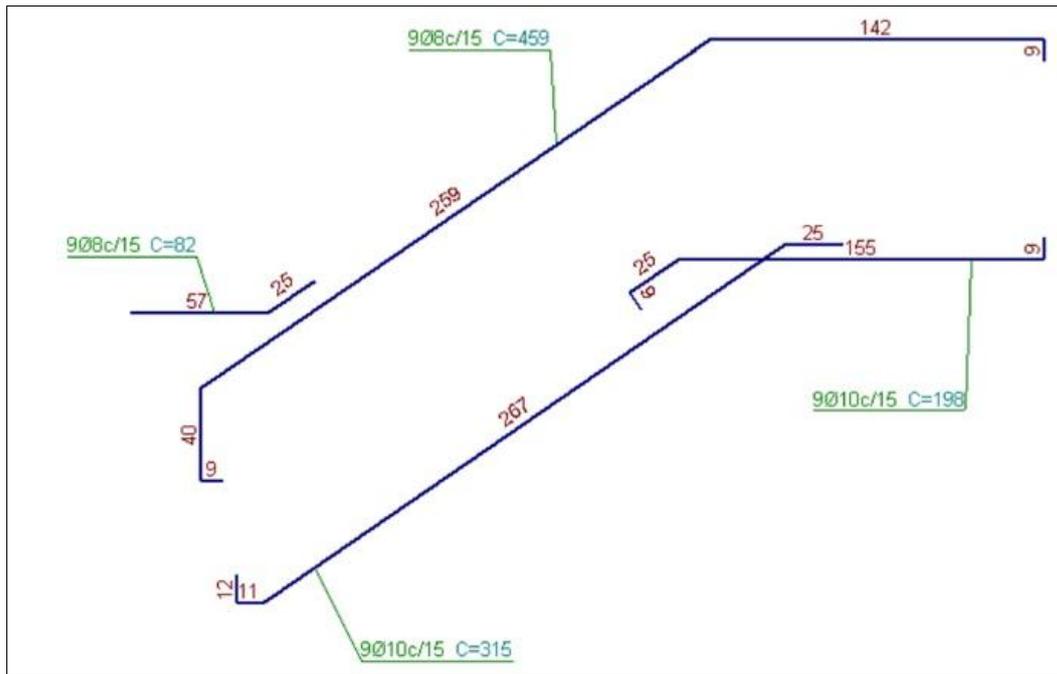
Detalhamento da armadura longitudinal do corte A-A
